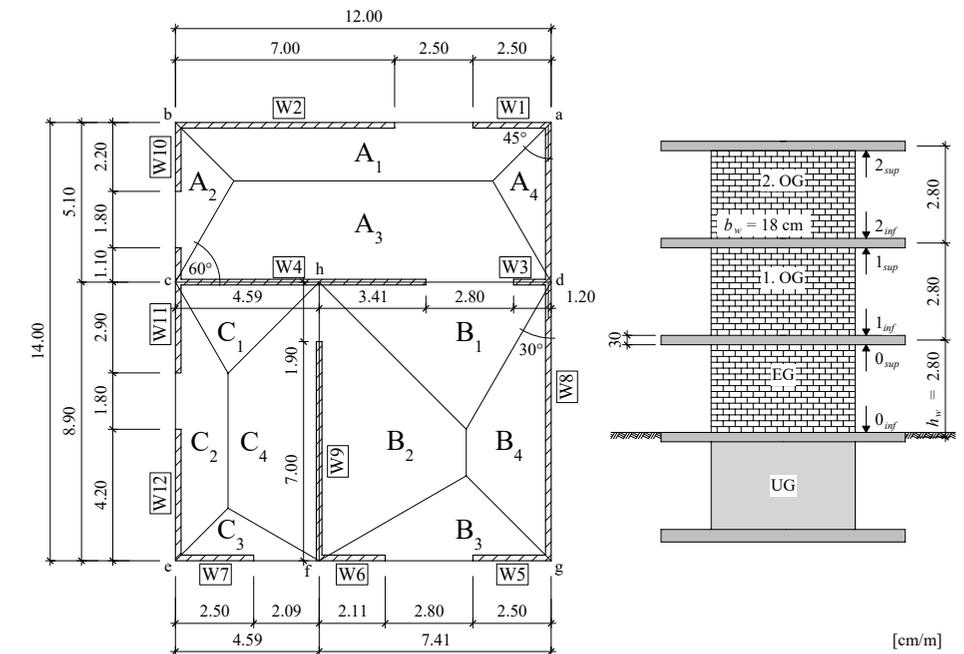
Beispielgebäude: (a) Wohnungsgrundriss; (b) Schnitt mit Tragwänden
